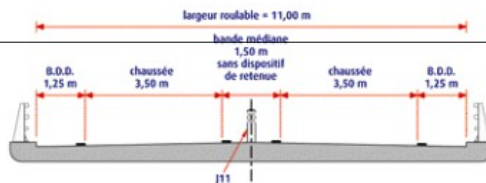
exemple de profil en travers minimal d'un ouvrage d'art non courant
